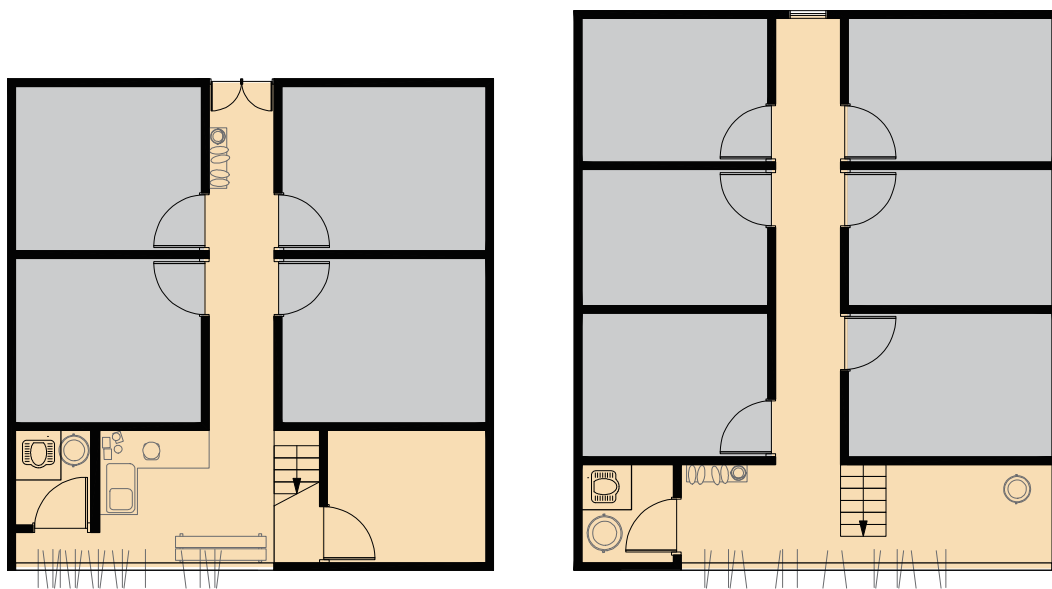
コス⑭;一階平面図 (左) と 2 階平面図 (右) (1:50)
